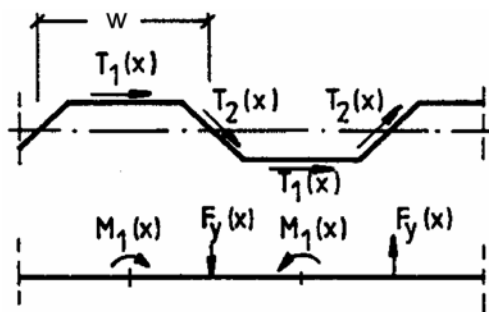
Поперечные нагрузки на пояс вследствие передачи усилий сдвига
